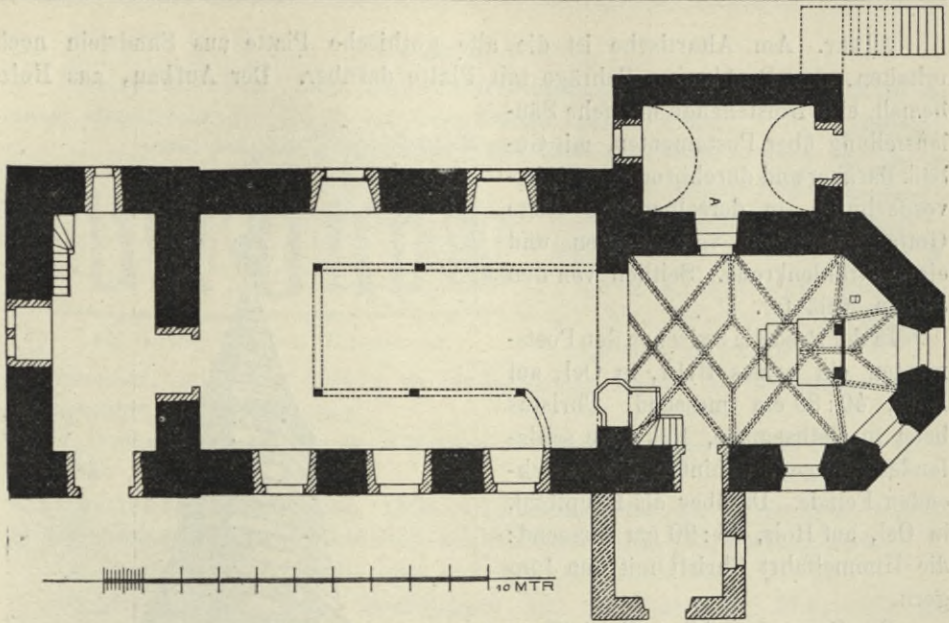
Kleinwolmsdorf, Grundriss der Kirche.
